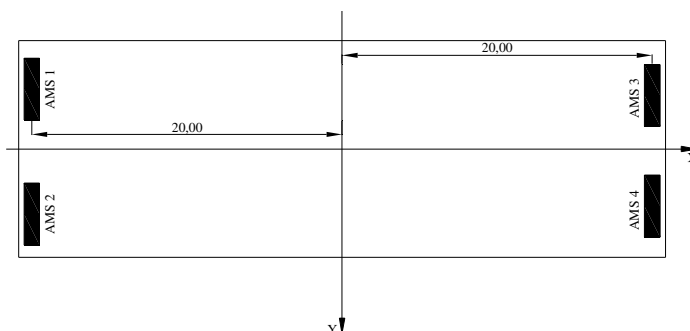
Edificio con Núcleo y Tabiques – Ubicación en planta de 4 AMS orientados según Y
